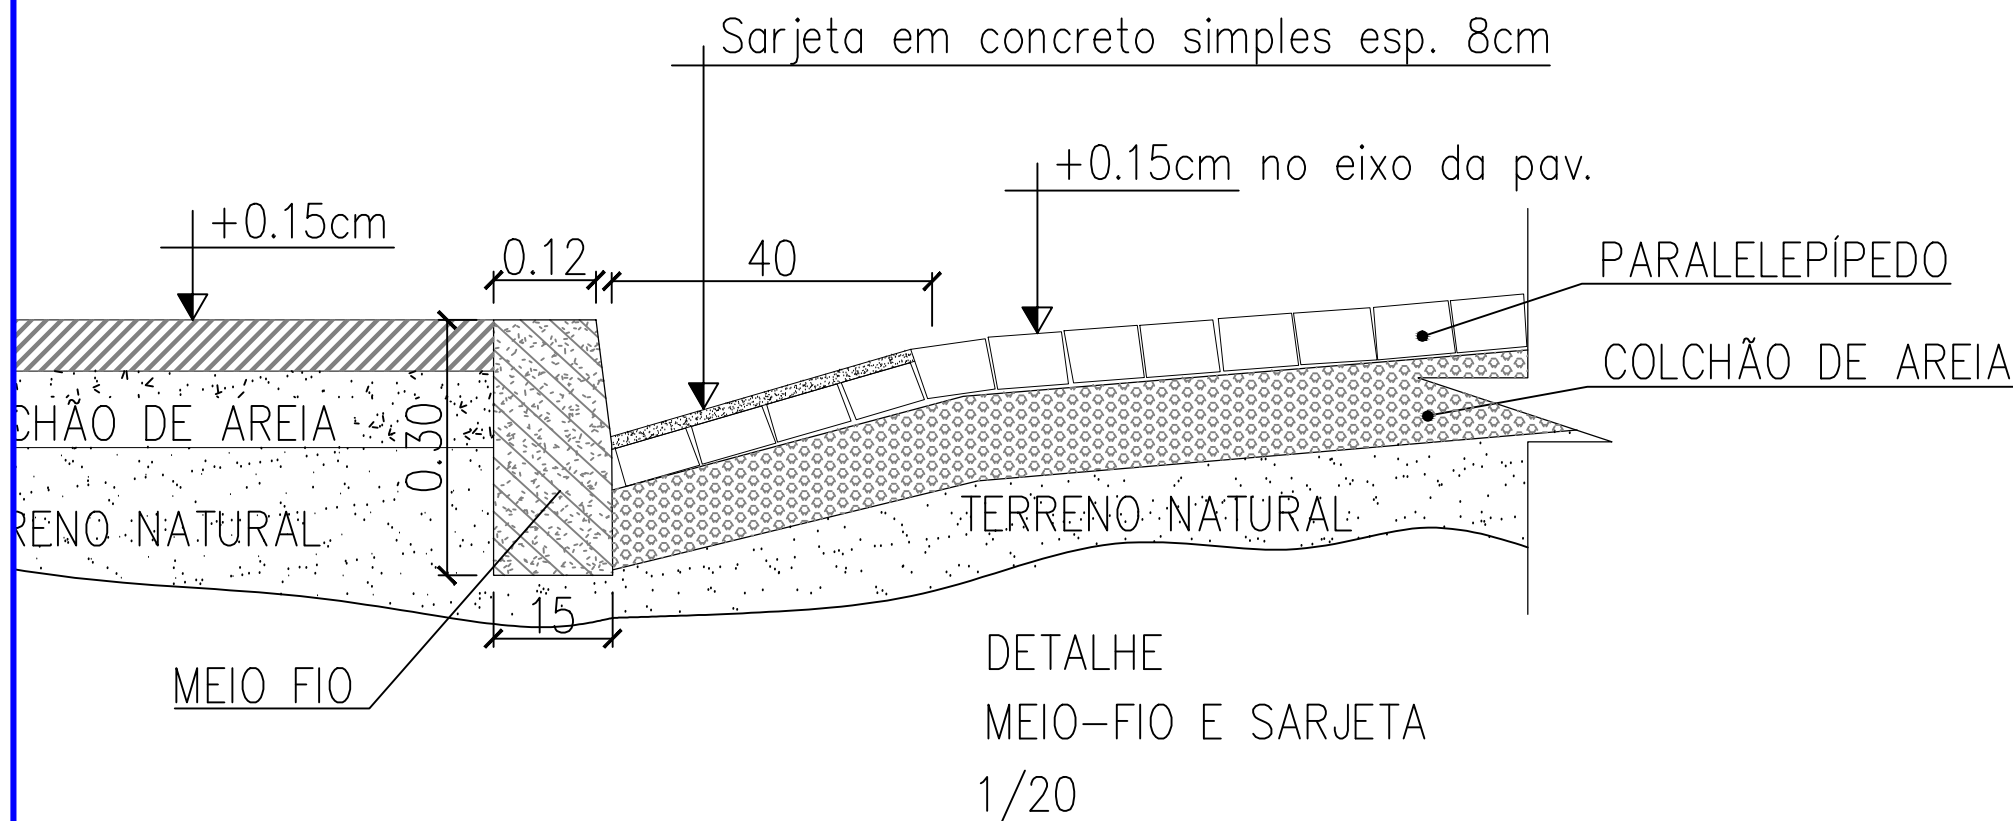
PAVIMENTAÇÃO SEÇÃO TIPO
